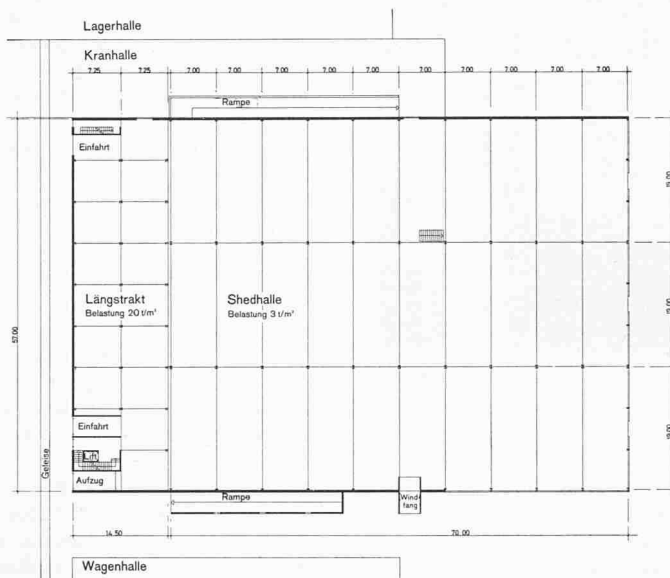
Erdgeschossgrundriss 1:1150 der Werkhalle mit dreigeschossigem Längstrakt und der grossen Shedhalle. Die Beschränkung in den Möglichkeiten der horizontalen Ausdehnung führt oft dazu, dass Fabrikationsräume in die oberen Geschosse verlegt werden. Hier sind die beiden Obergeschosse des Längstraktes für Nutzlasten von 2 t/m² dimensioniert
